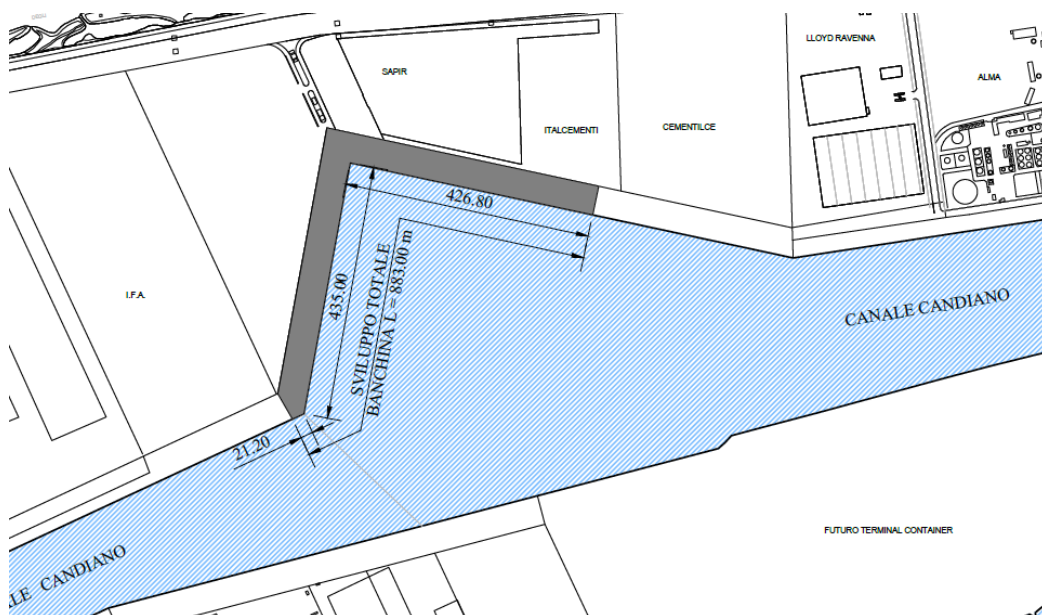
Key Plan intervento Trattaroli Sud - Progetto Definitivo
